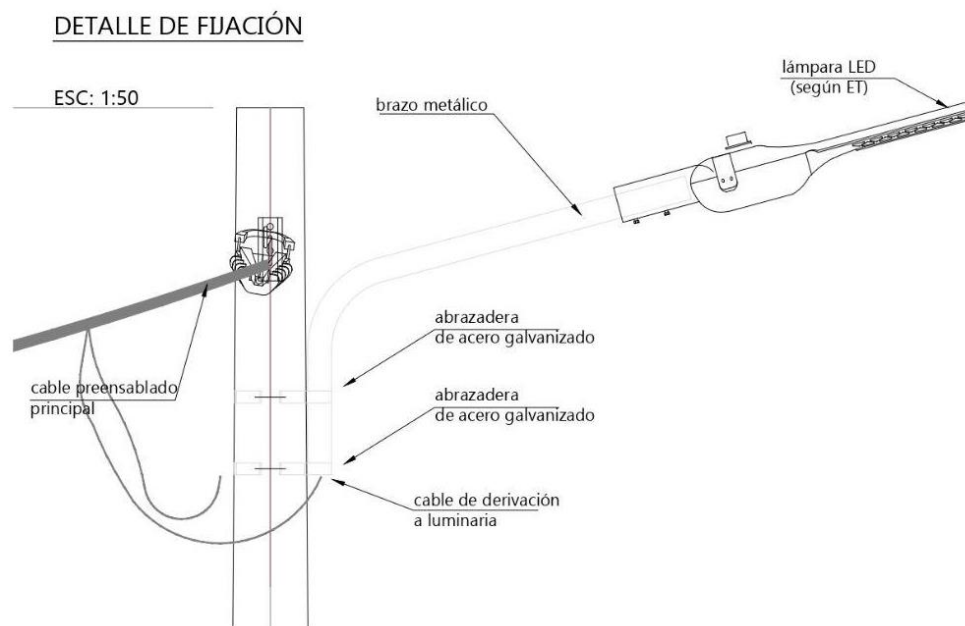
Esquema de instalación de brazo metálico sobre viga poste de madera.
